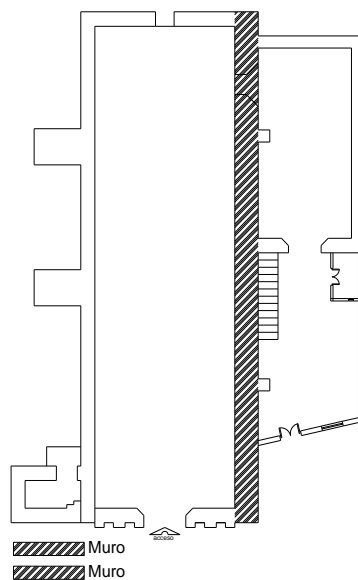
Reforzamiento en los externos con sillarías de piedra<sup>2</sup>, en la capilla de San Nicolás Tolentino. Autor JOBG, Año. 2017
